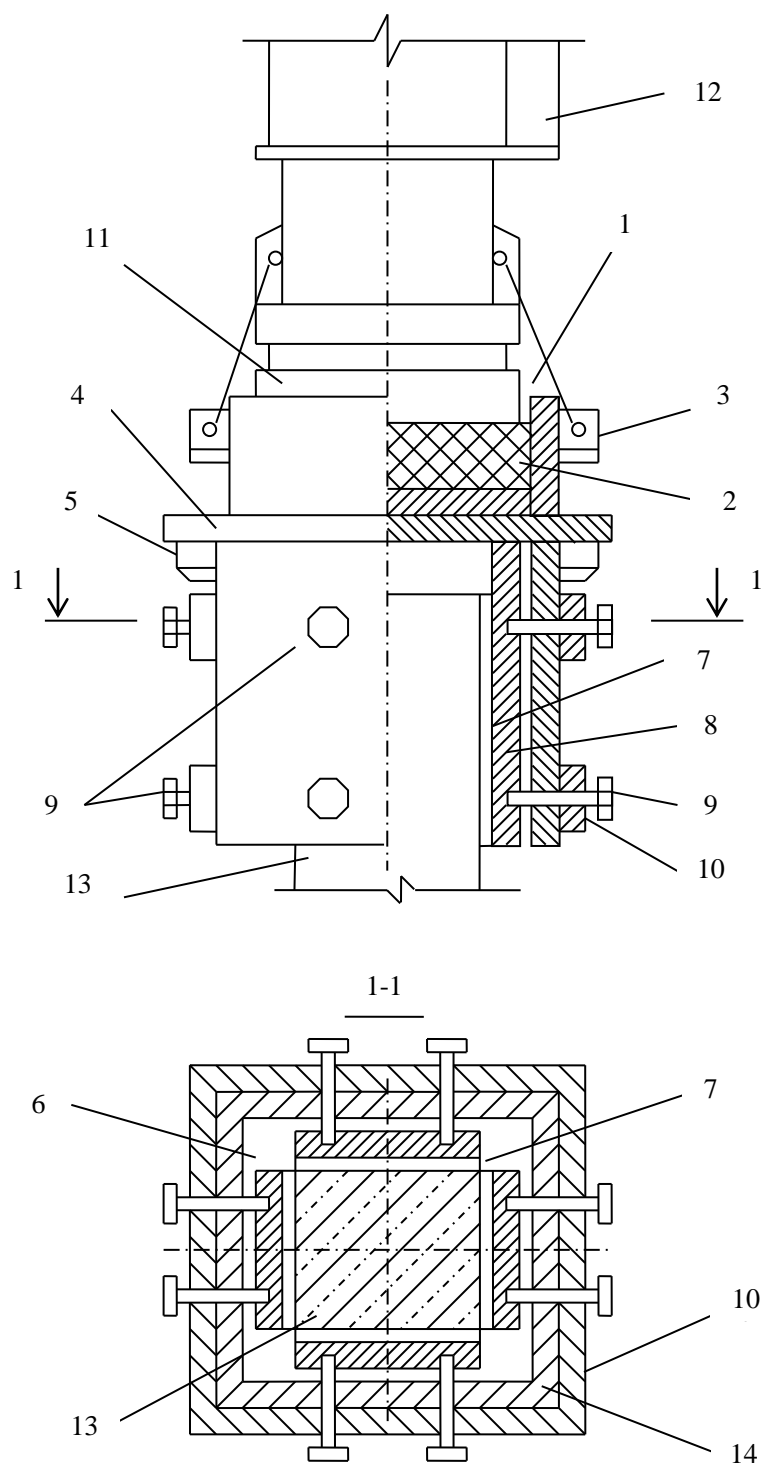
Схема свайного наголовника с боковой передачей усилий к свае
